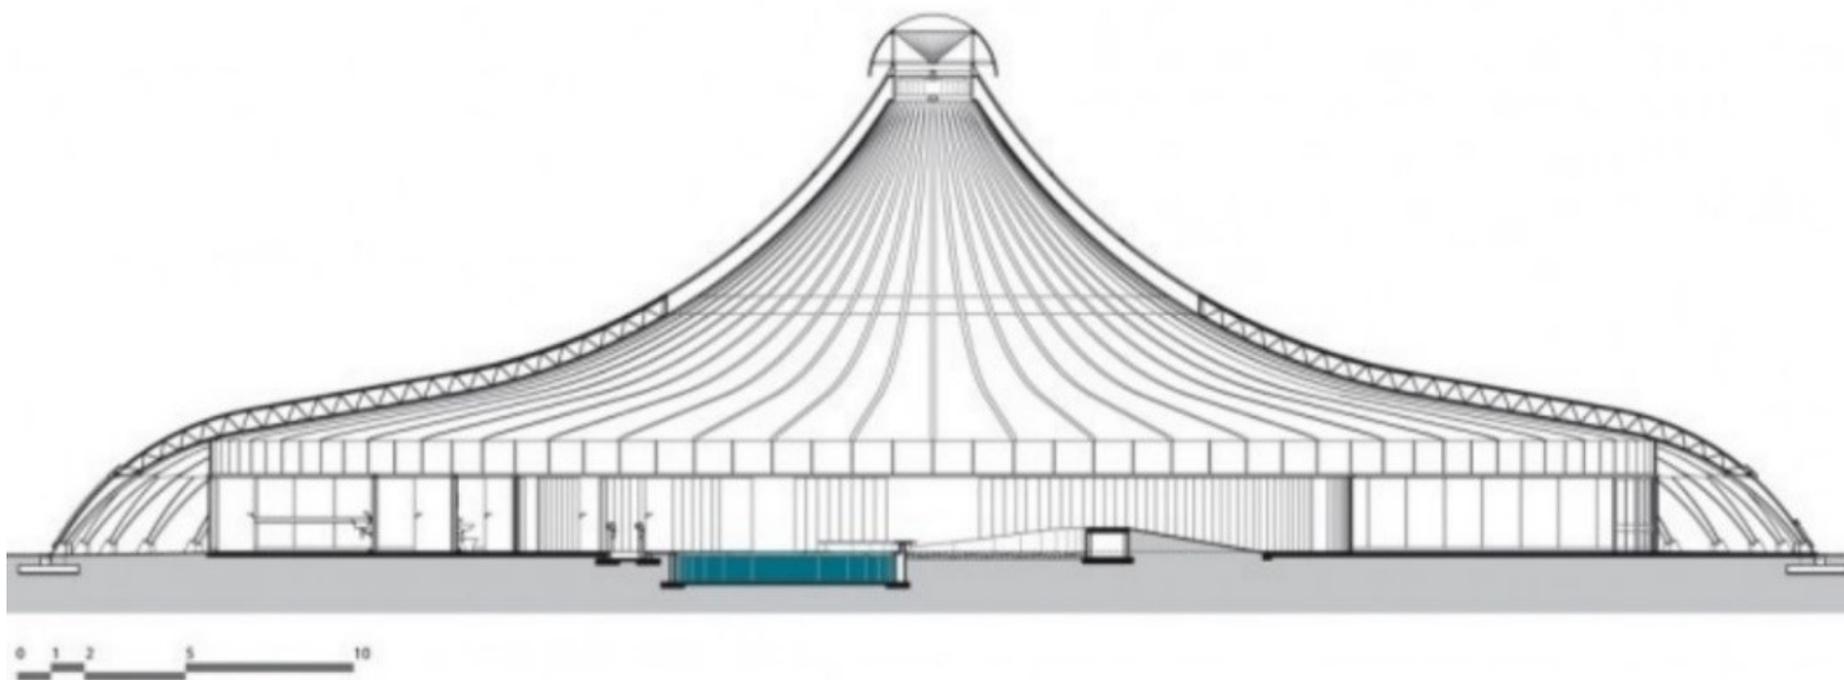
Sarah Lago Norte Brasília – Prédio principal – Corte -
